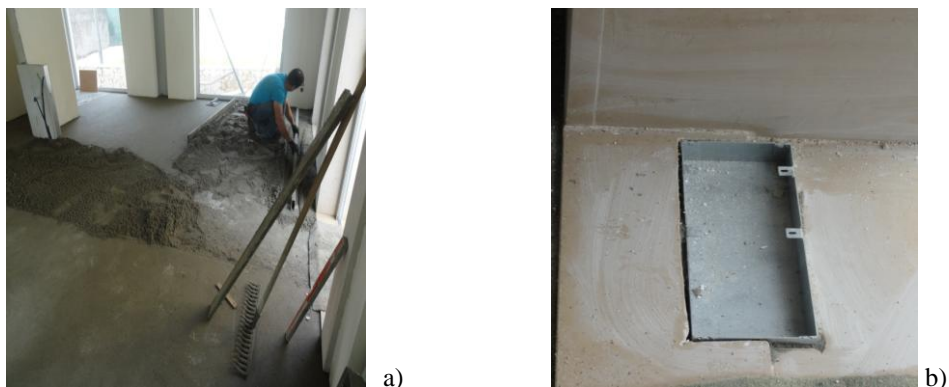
a) Execução de pavimentos; b) Pormenor da caixa do dispositivo de abertura da porta de vidro.
